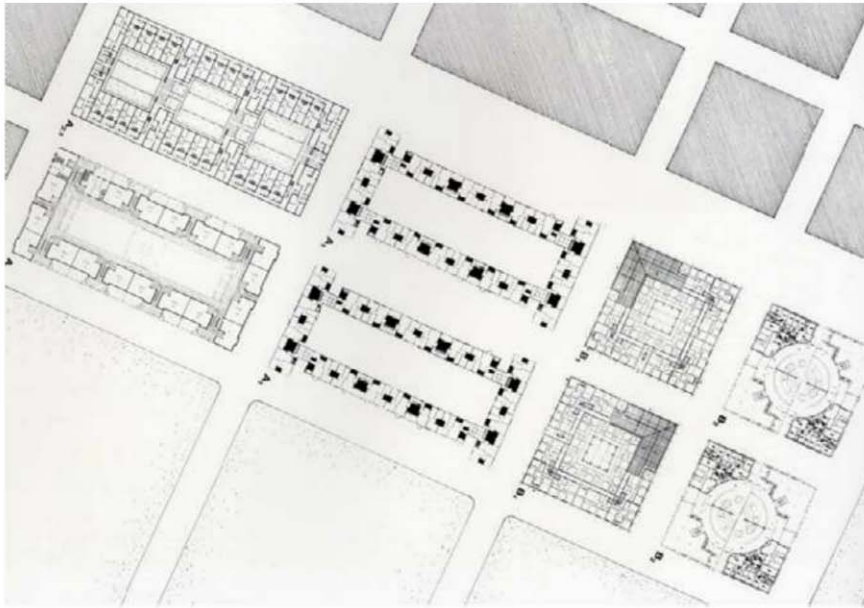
Primeras manzanas construidas tras la Modificación del Plan Parcial en 1982. Id. Fig. 5
